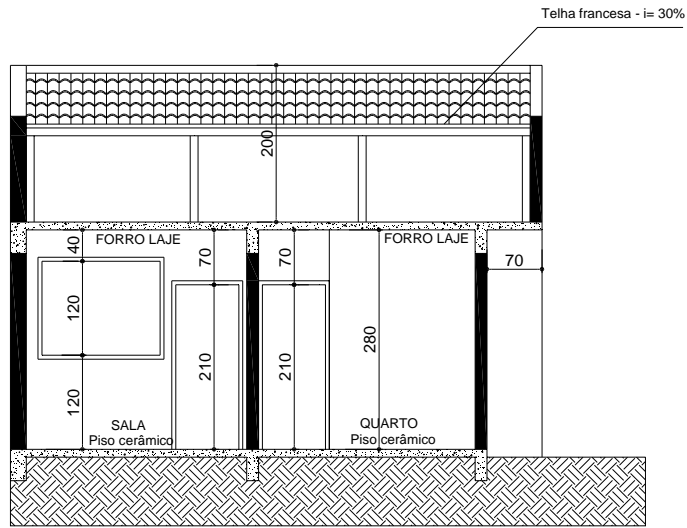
Unidade em construção em alvenaria nova 2 – 4ª fase
